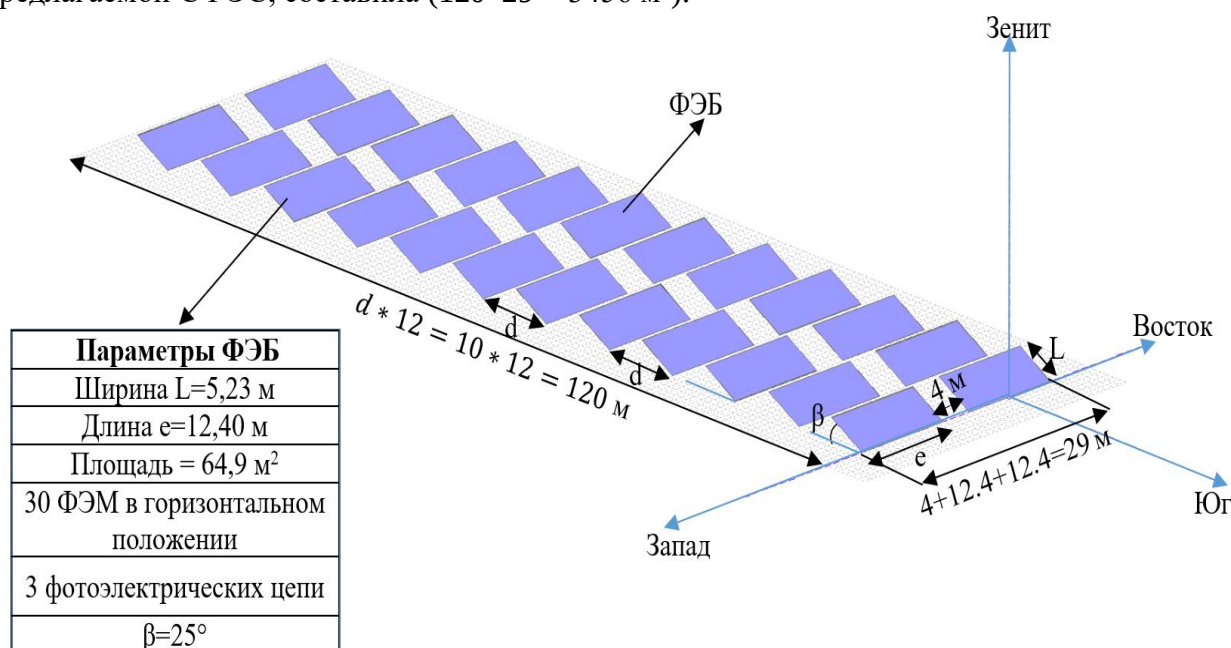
Генеральный план размещения оборудования СФЭС
